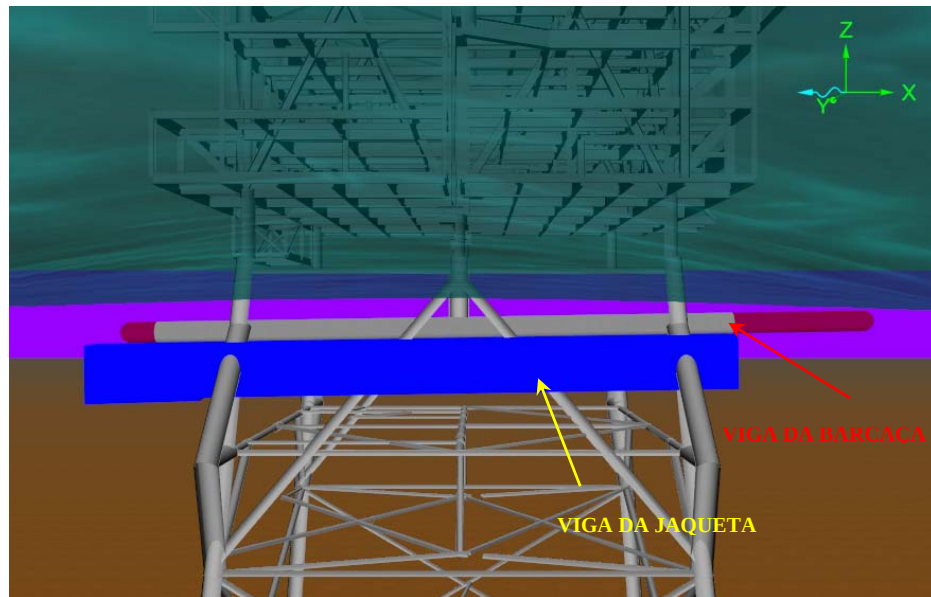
Viga da jaqueta em contato com a viga da barça no momento da instalação.
